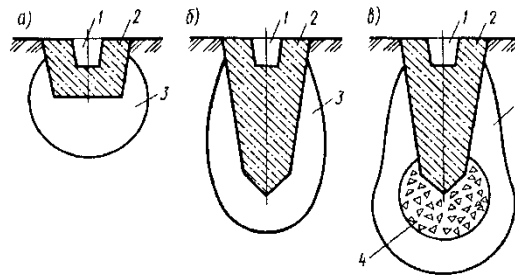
Схемы устройства методом вытрамбовывания котлованов фундаментов с плоской подошвой (а), с заостренной подошвой обычного типа (б) и с уширенным основанием (в):
